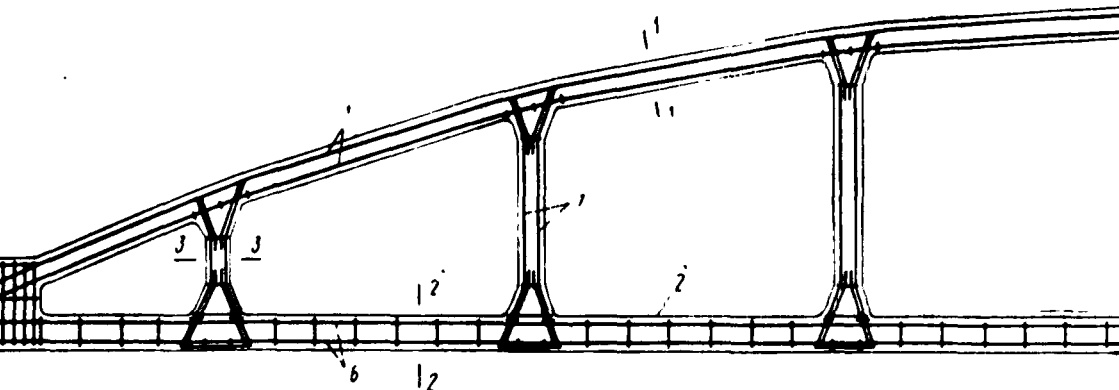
Типовая безраскосная ферма пролетом 24 м для скатной кровли
